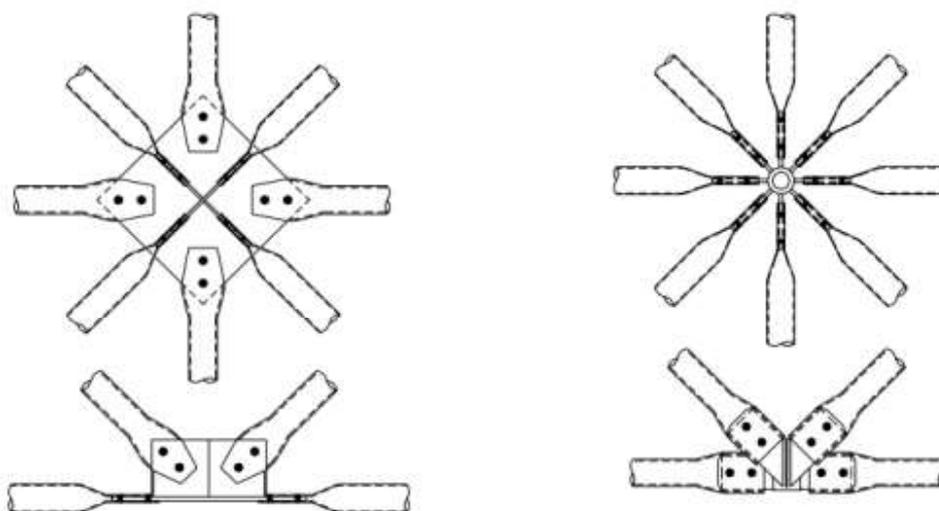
e 13 – Conexões metálicas em caixa ou estrela não-articulada
